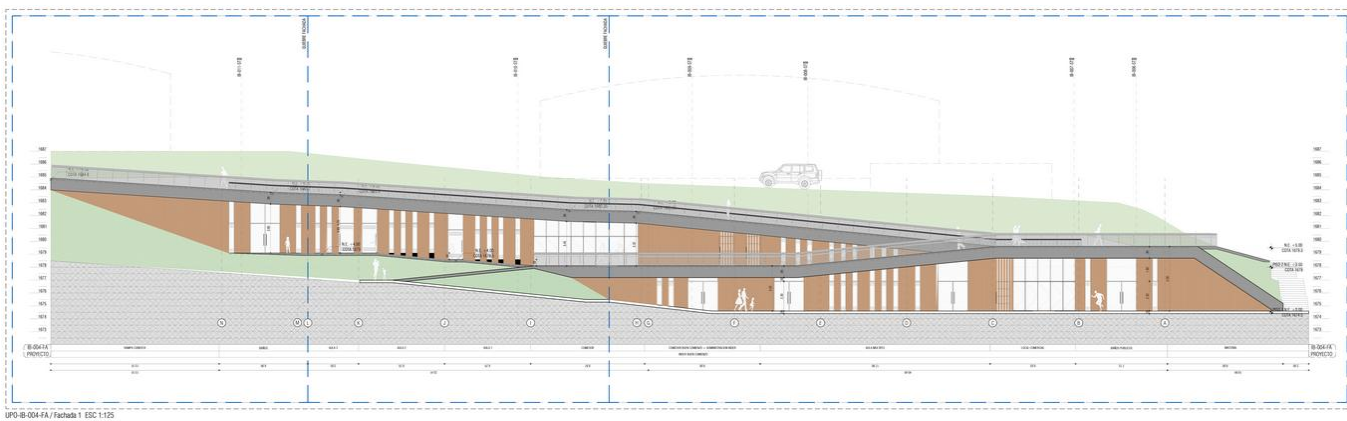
Fachada do Edifício Jardim Buen Comiezo. Fonte: site EPM.
